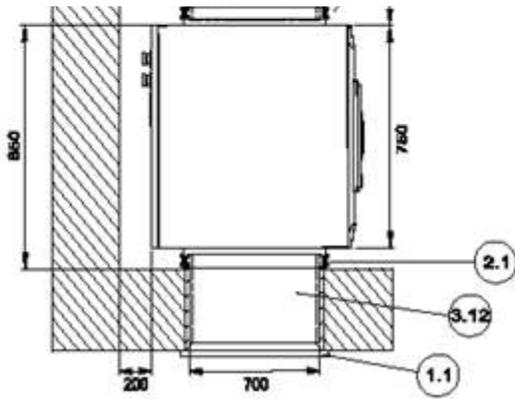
Vista dall'alto - LI 16TES, LI 20TES (installazione a parete con canale aria lato mandata)
